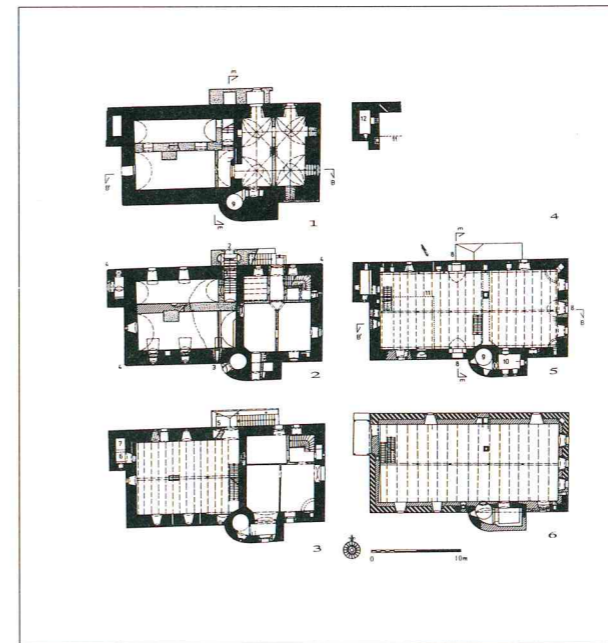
Feste Litovice. Grundrisse der einzelnen Ebenen. 1 - Kellergeschoss, 2 - Erdgeschoss, 3 - 1. Obergeschoss, 4 - Zwischengeschoss, 5 - 2. Obergeschoss, 6 - 3. Obergeschoss. Nach M. Rykl
